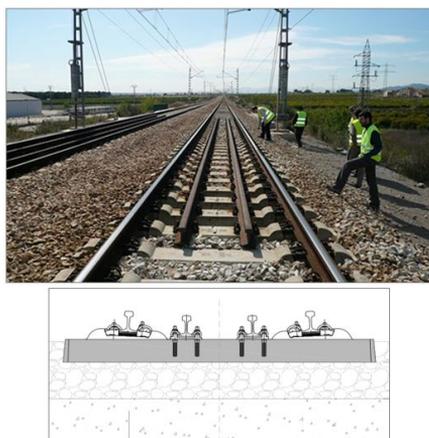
Disposición de carriles adicionales sobre traviesa en zonas de transición placa-balasto
